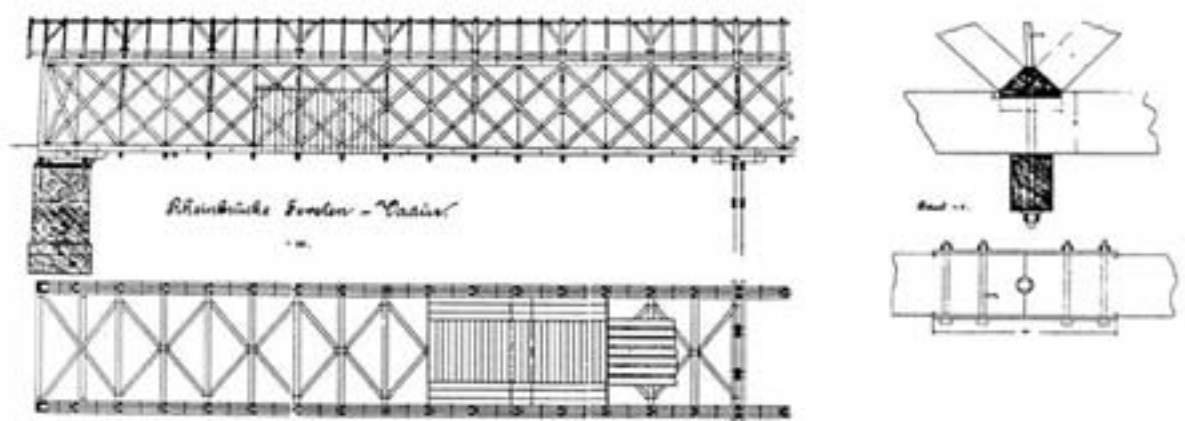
(oben): Deutlich wird der geringe Holzverbrauch beim System Howe. Es sind auch keine sehr massiven Balken notwendig. (Stadelmann, Werner. Holzbrücken der Schweiz. Chur 1990: S. 274)
